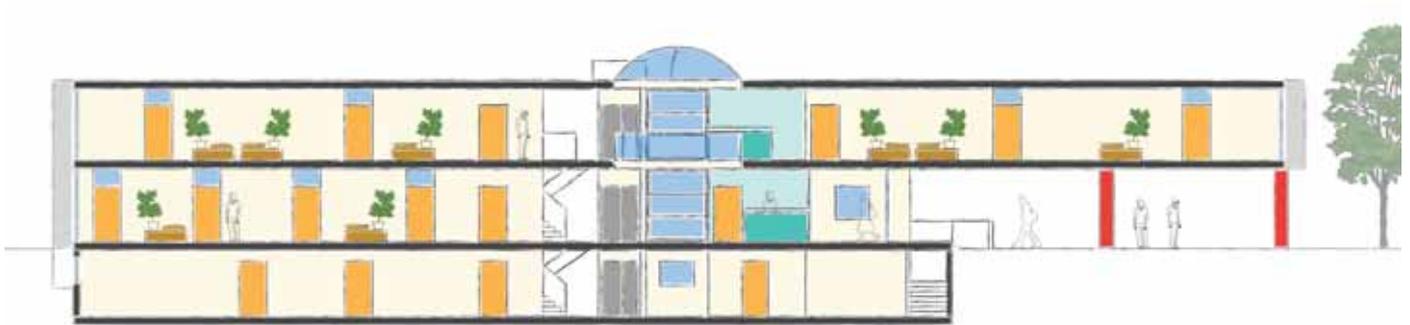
Schnitt - Kreuzgebäude - Eingang / Foyer / Ganzzone
